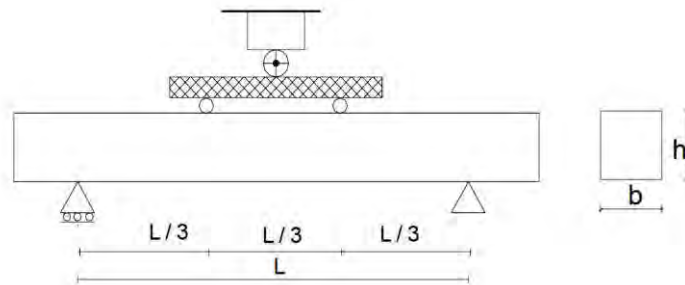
Montaje para los ensayos experimentales de flexión en vigas de concreto reforzado y fibras de acero.
